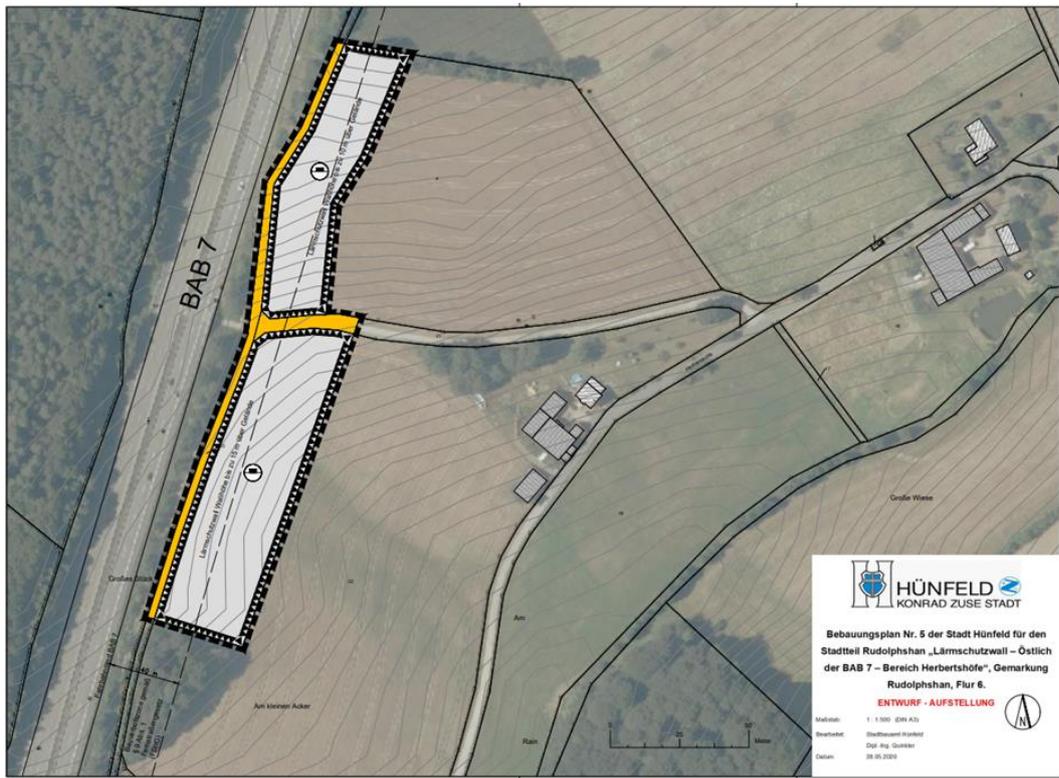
Bebauungsplan Lärmschutzwall Herbertshöfe [Quelle: Stadt Hünfeld]
